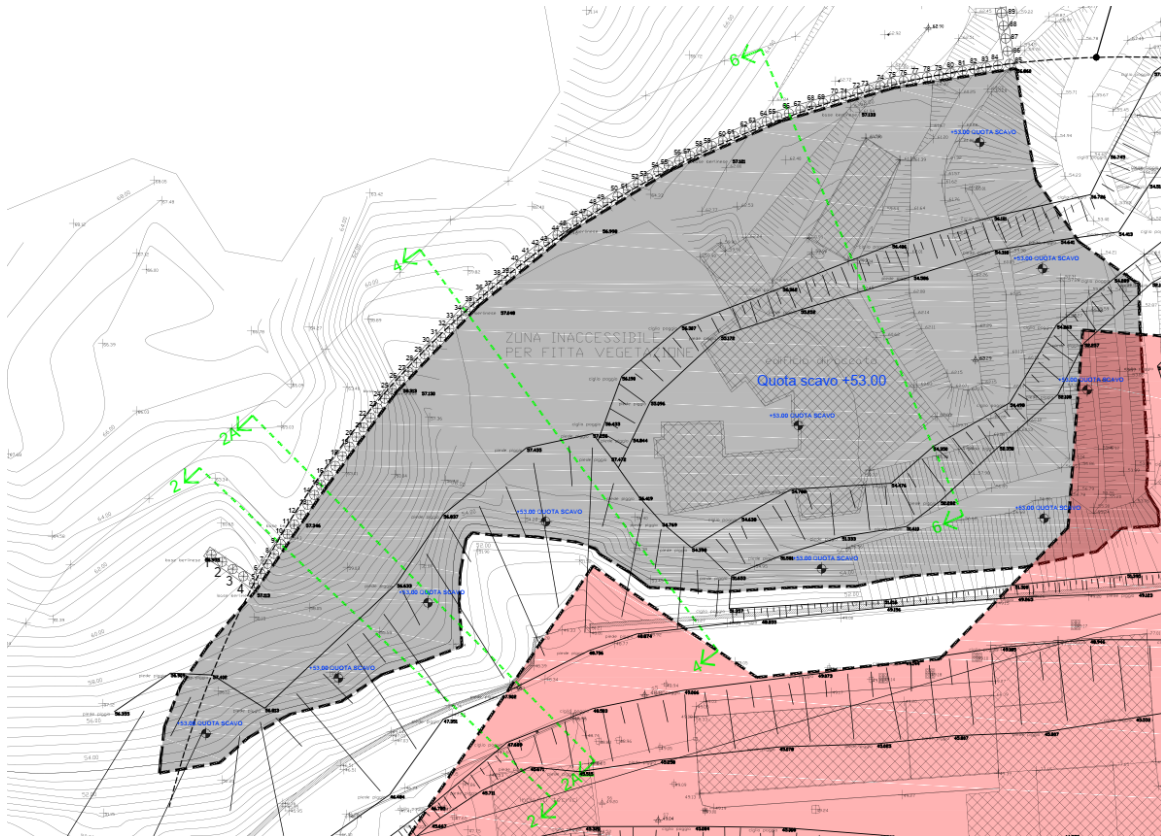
Dettaglio planimetria berlinese con le quattro sezioni tipo
